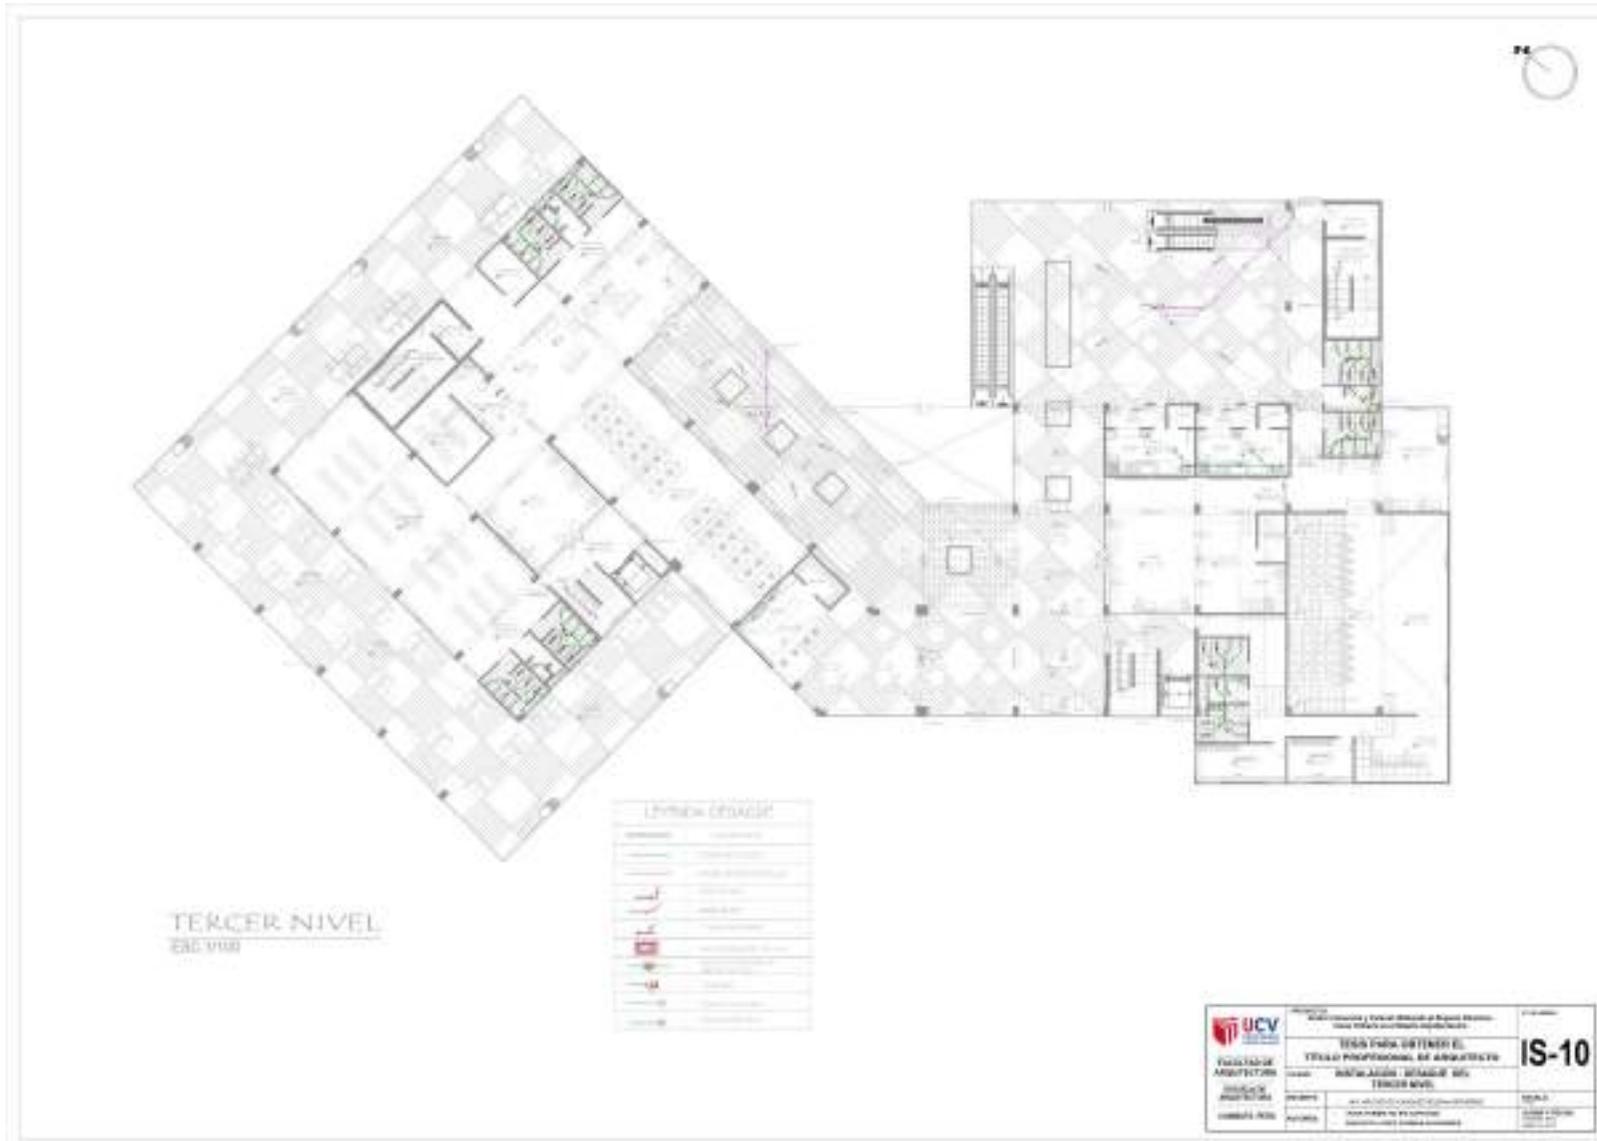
Plano de instalación de desagüe y pluvial tercer piso
